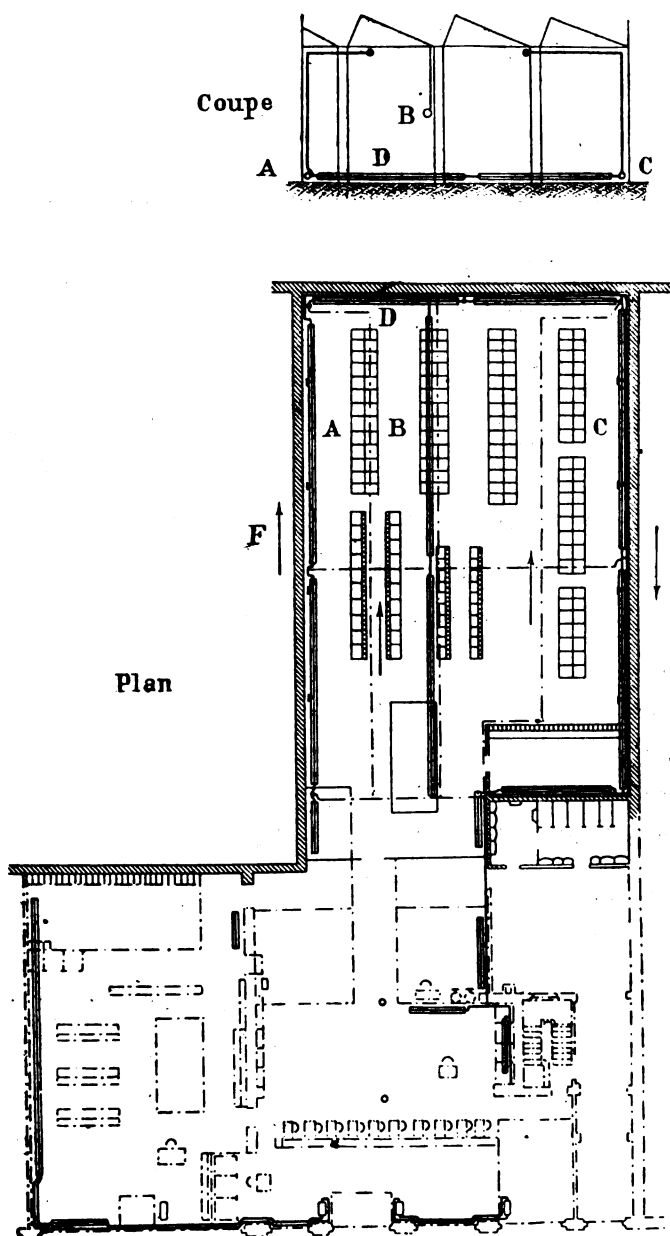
Coupe et plan d'un projet de chauffage pour le bureau de poste de la place Vaugirard.
